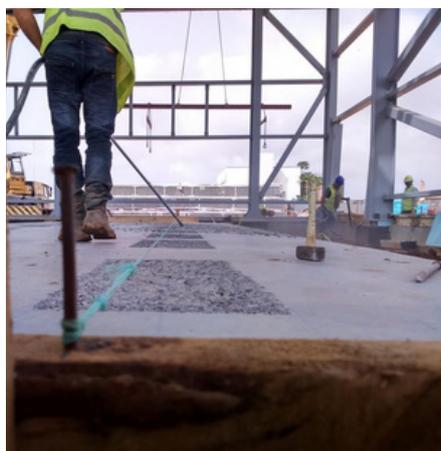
Picagem para atribuição de rugosidade à futura superfície de contacto com grout.
